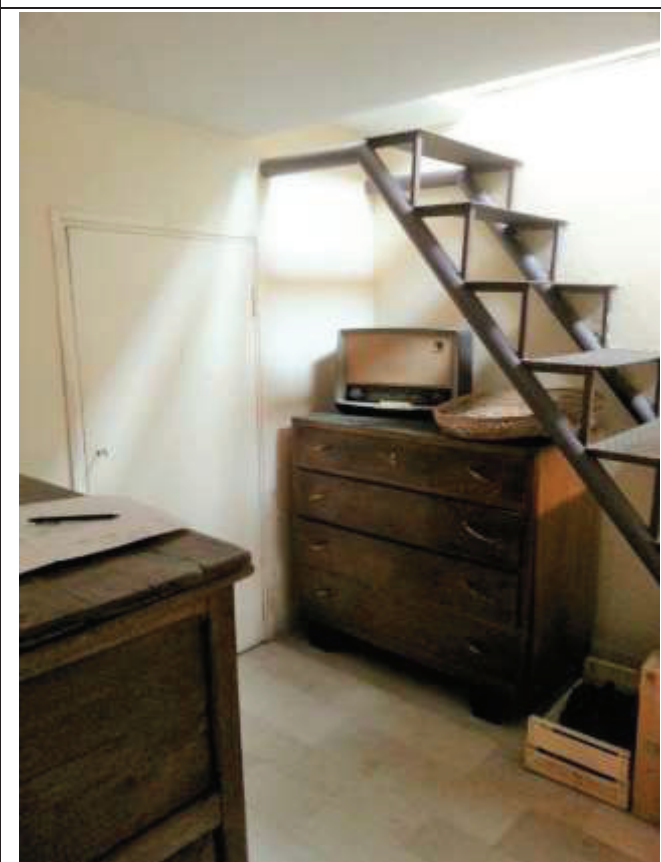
Pianerottolo della soffitta. Si osserva la scala metallica che collega alla torretta in copertura. Zona abitabile della soffitta (soffitta 1). Si osserva sullo sfondo la porta d'accesso al terrazzo (lastrico solare).
